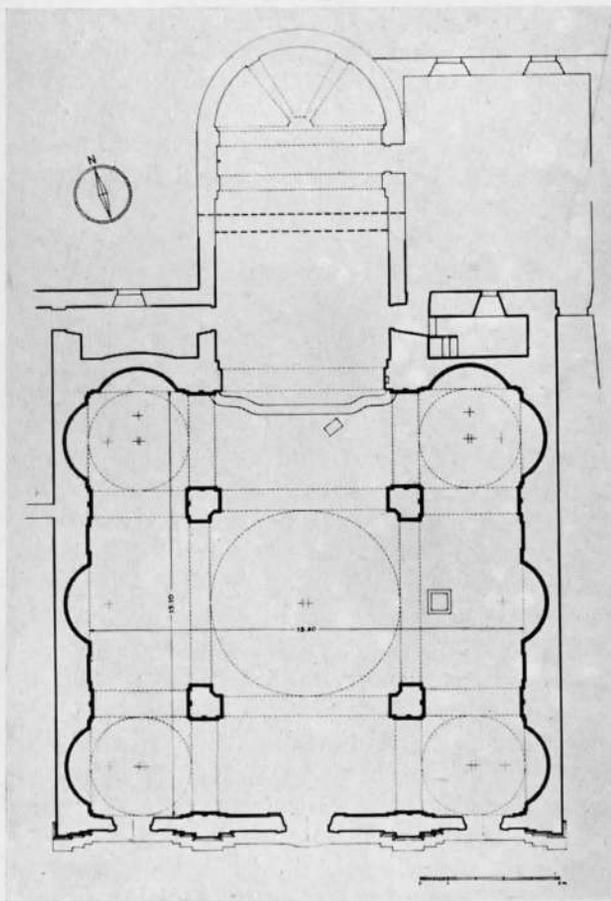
ROCCAVERANO, CHIESA PARROCCHIALE - PIANTA
